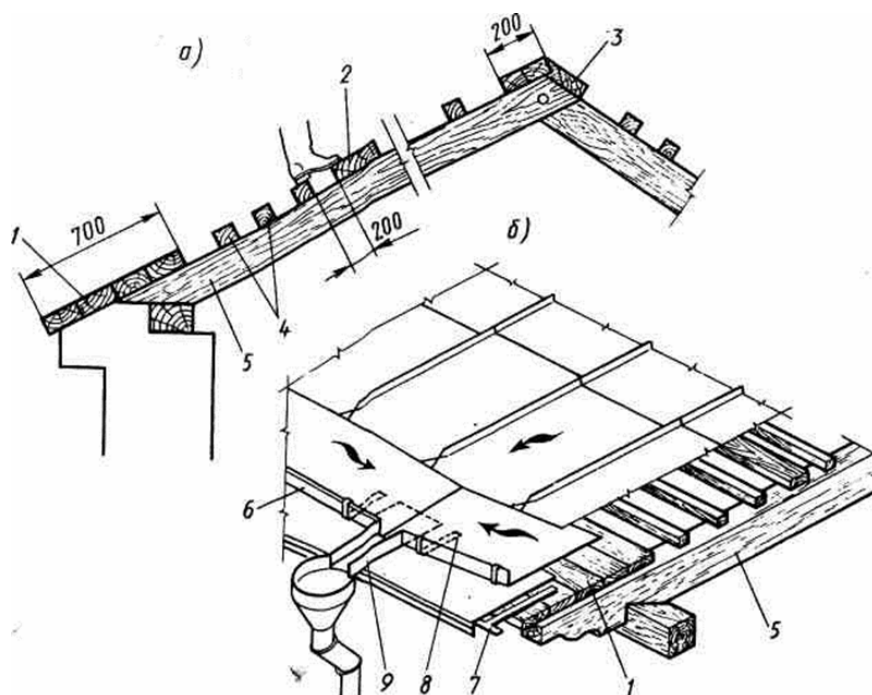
Схема устройства обрешётки под фальцевую кровлю и фрагмент готовой кровли:
